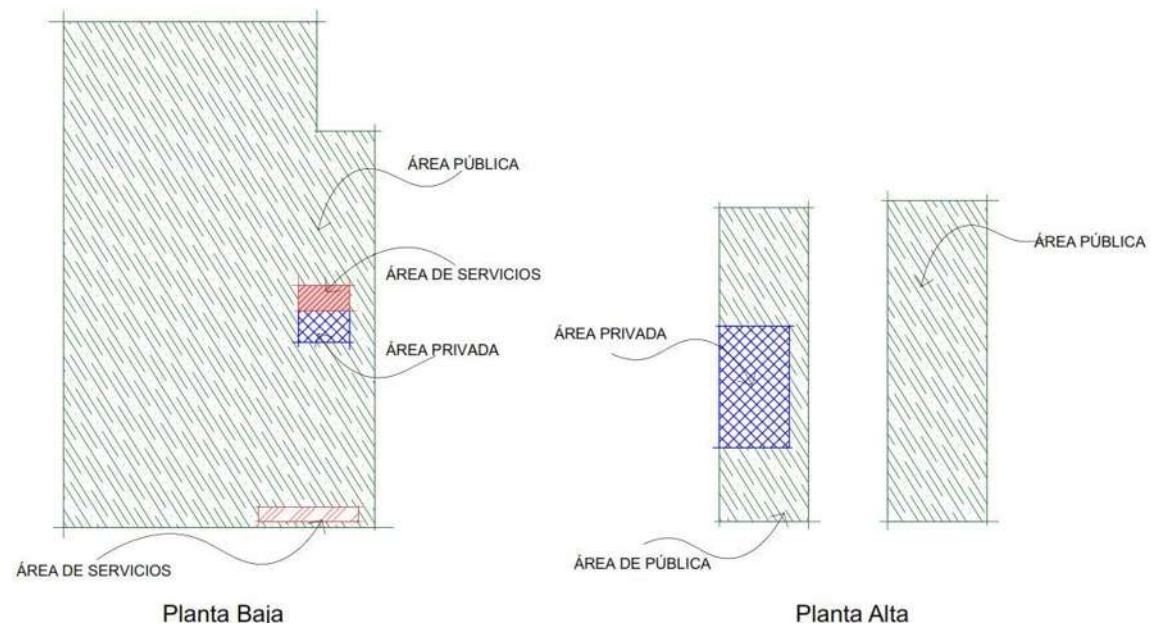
Propuesta de zonificación en planta baja y planta alta. Elaboración: del autor. Año: 2017.
